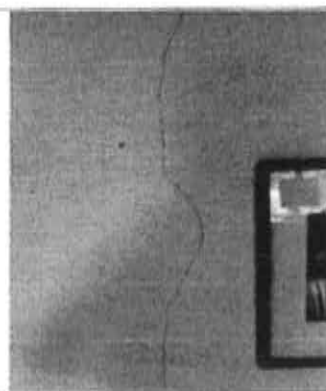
Fisura en cubículo Dr. Gilles
